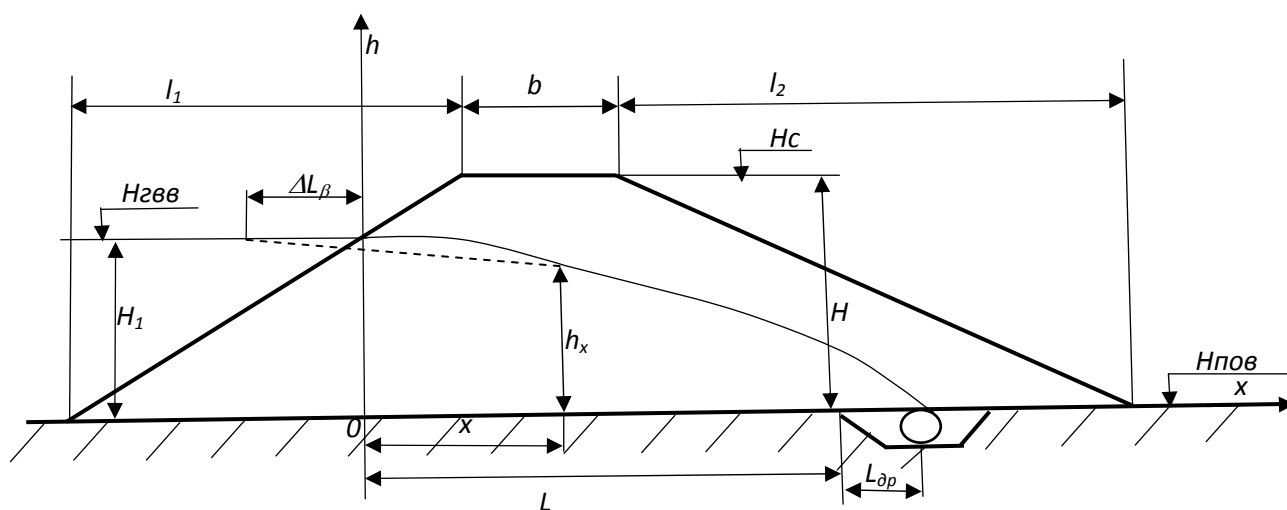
Расчетная схема однородной дамбы на водонепроницаемом основании с трубчатым дренажем
